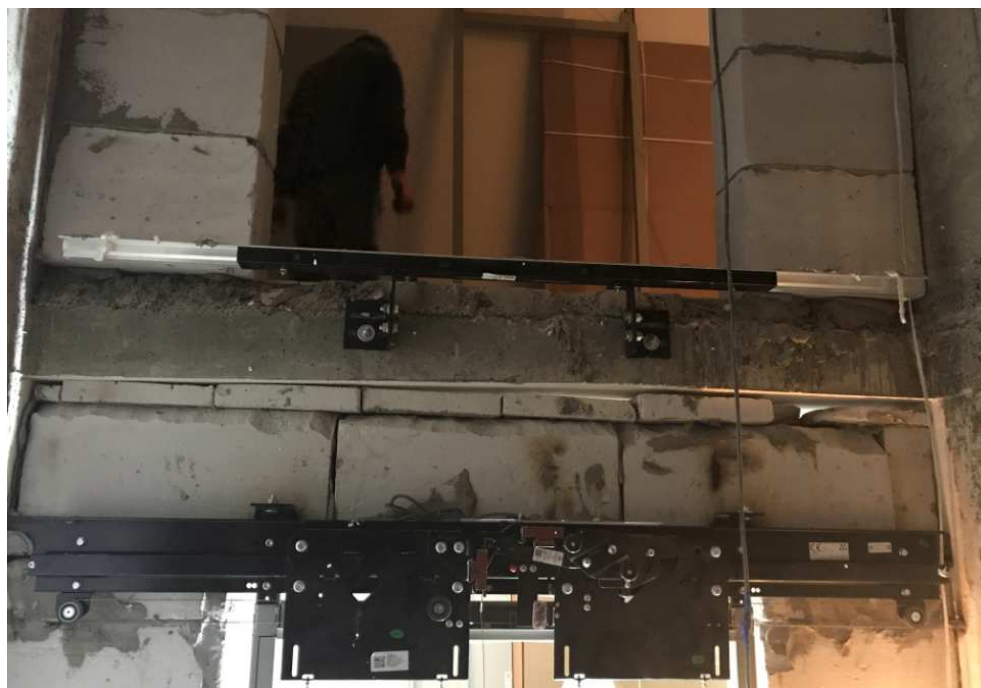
Общий вид установленных порога посадочных площадок и подвесных механизмов шахтных дверей
